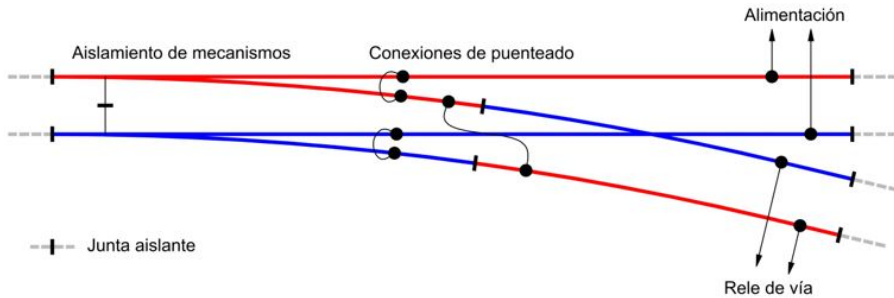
Esquema de disposición de las juntas aislantes encoladas en un desvío
